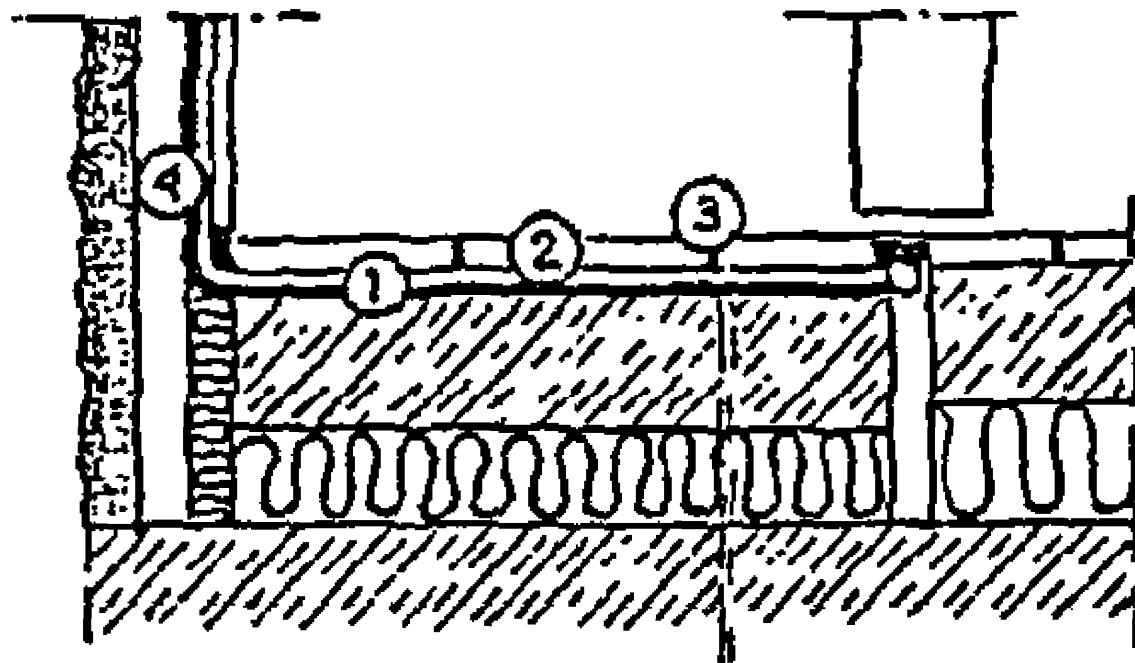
Гидроизоляция под плитку. Капитальное строительство:
